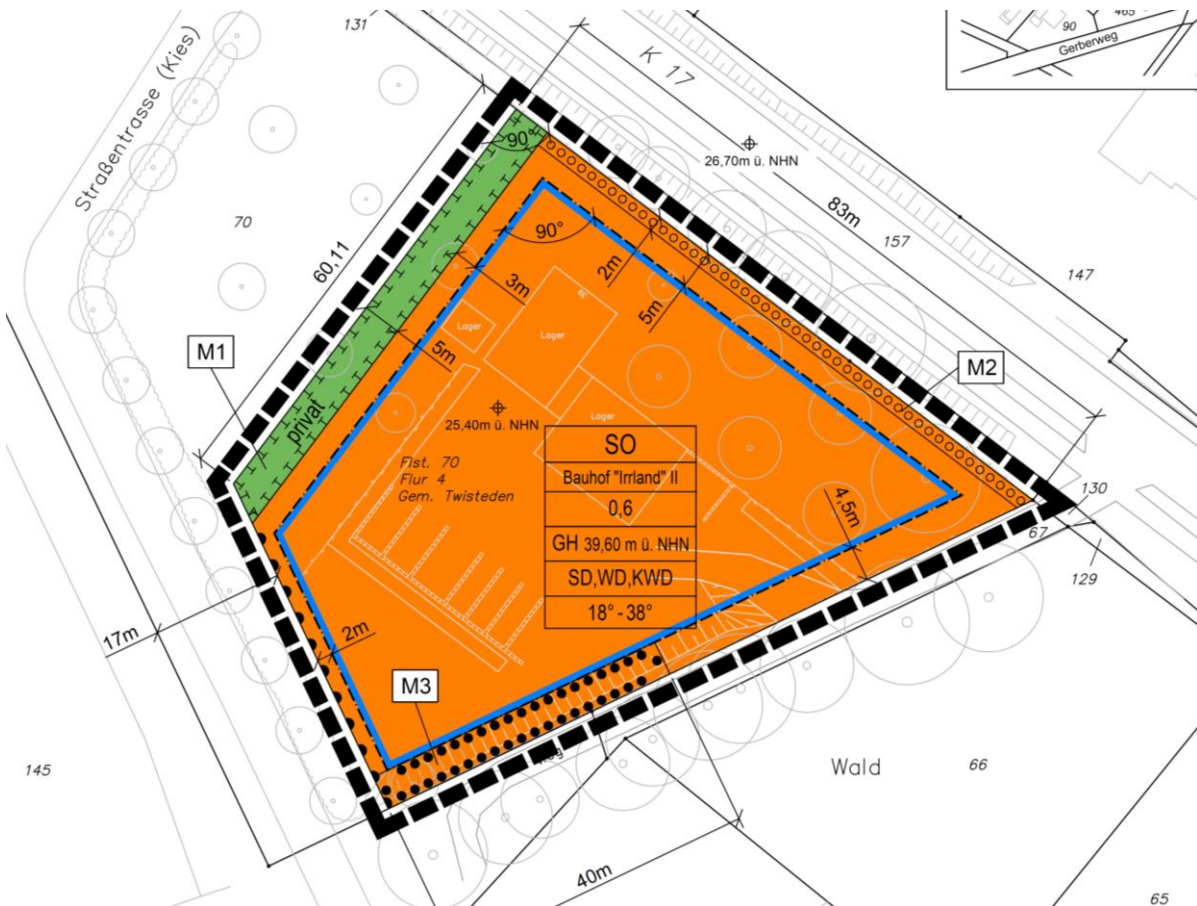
Ausschnitt Bebauungsplan Twisteden Nr. 21 (Bauhof „Irrland“ II) der Wallfahrtsstadt Kevelaer (Entwurf, Oktober 2024)
